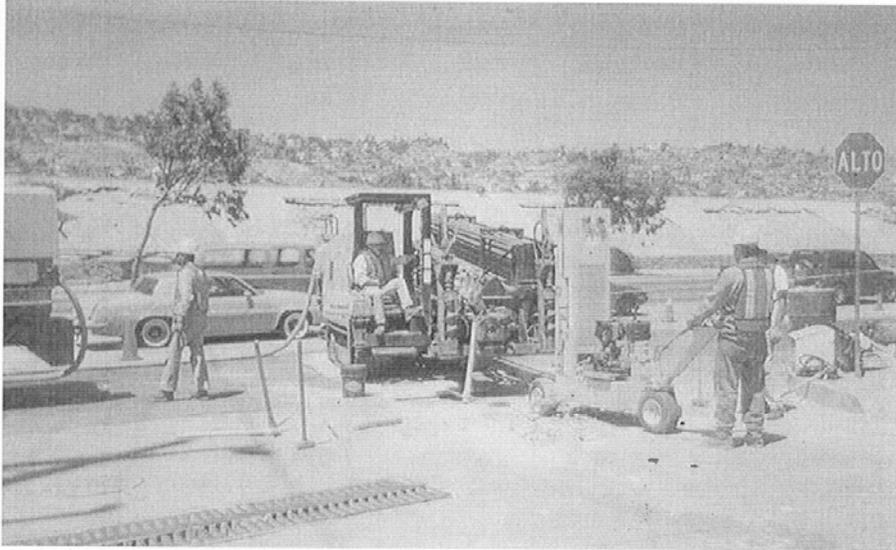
Máquina de barrenación direccional, tipo Veermer 6015
